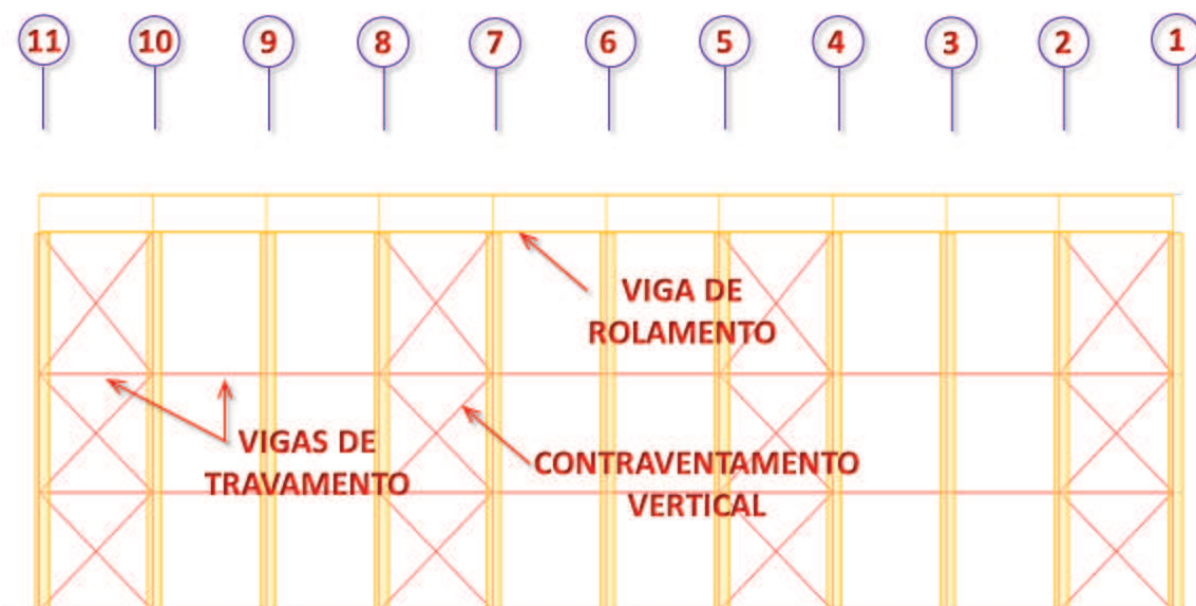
Vista do contraventamento vertical interno e das vigas de rolamento.
